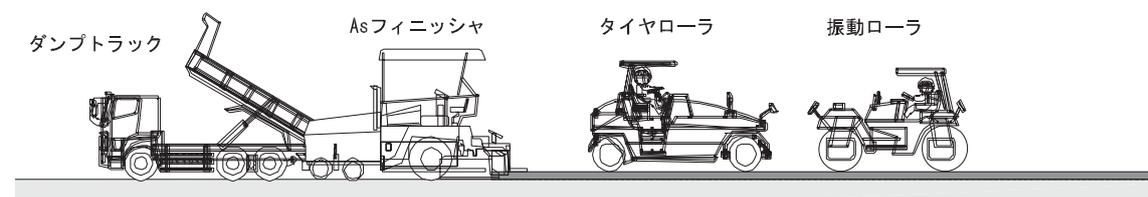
アスファルト舗装工（表層）の施工状況
